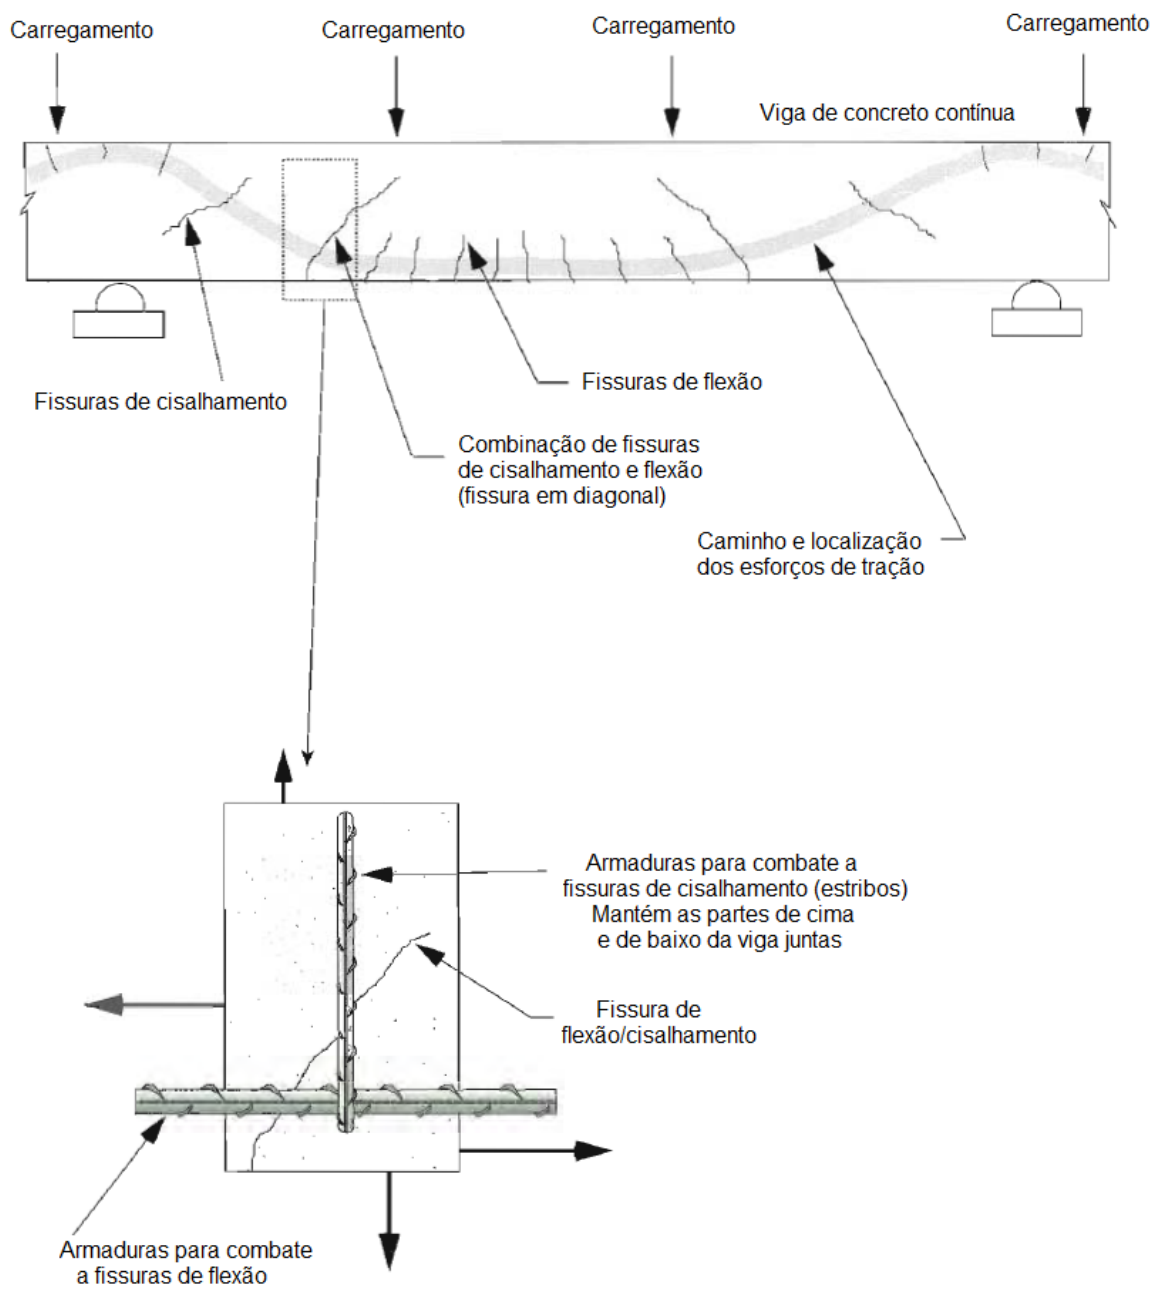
Fissuras em vigas de vãos contínuos. (Fonte: Emmons, 1994 – adaptado).
